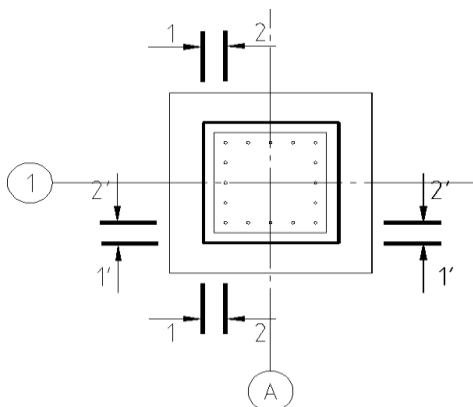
Схема до розрахунку армування плитної частини фундаменту
